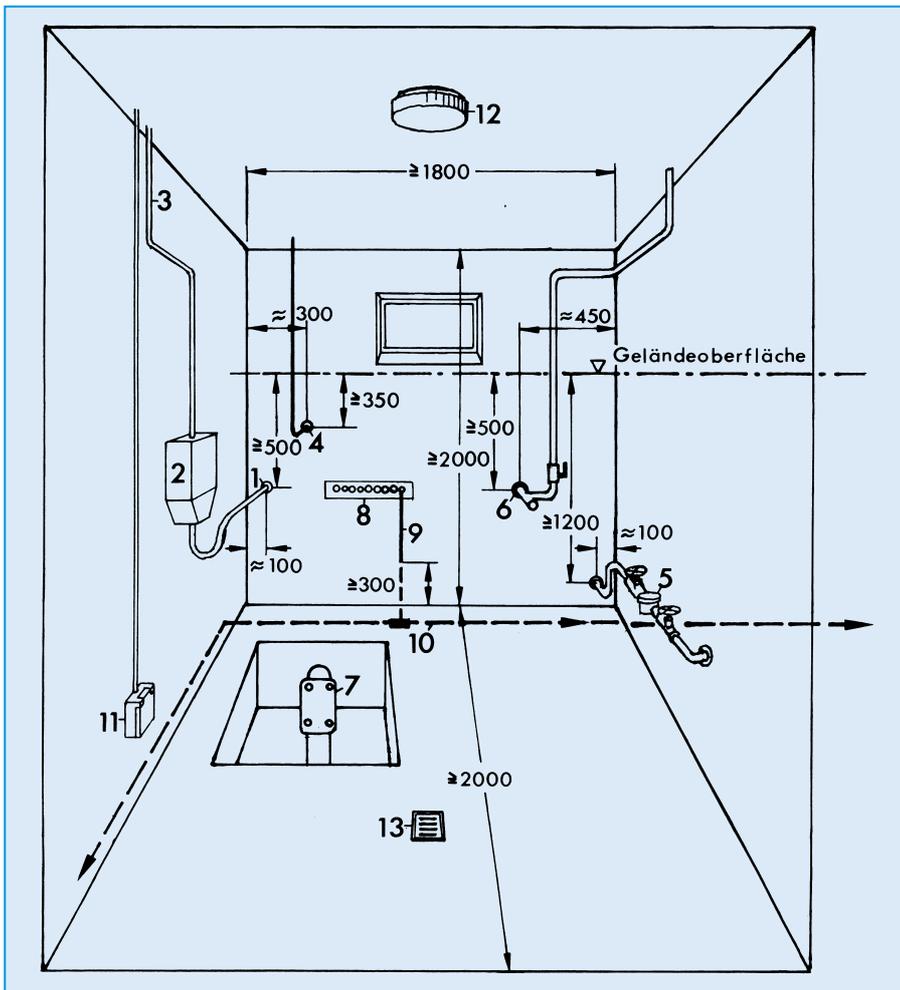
Hausanschlussraum mit Anordnung der Anschlussleitungen; 1 Hauseinführung Starkstrom, 2 Starkstrom-Hausanschlusskasten mit Hausanschluss Sicherungen, 3 Starkstrom-Hauptleitung, 4 Hausanschlussleitung Fernmeldeanlage, 5 Hausanschlussleitung Trinkwasser mit Hauswasserzähler, 6 Hausanschlussleitung Gas mit Hauptabsperreinrichtung, 7 Abwasserleitung mit Revisionsöffnung, 8 Potenzialausgleichsschiene, 9 Anschlussfahne, 10 Fundamenteerde, 11 Steckdose, 12 Leuchte, 13 Bodenablauf mit Rückstauverschluss
